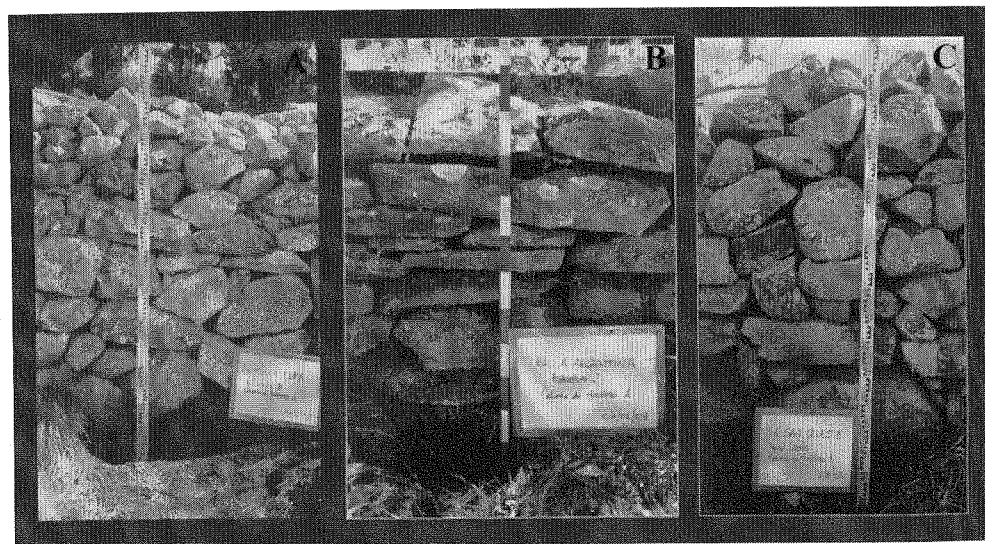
Construcciones de piedra situadas en la zona de estudio de donde provienen las muestras de suelo analizadas
